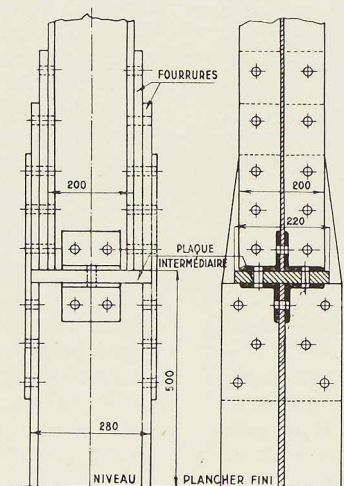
Assemblage type de deux poutrelles de dimensions différentes. Cet assemblage comporte une plaque intermédiaire.
